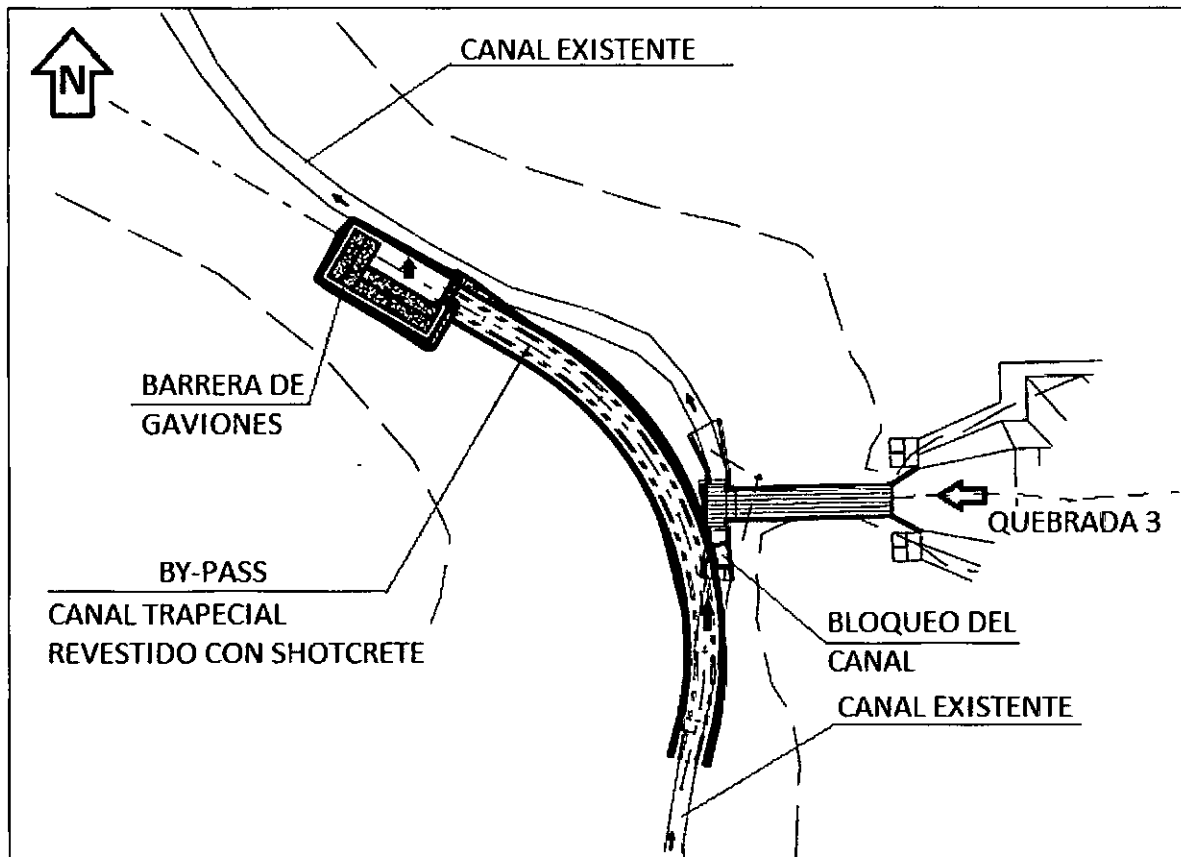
By-pass de canal en Obra de Arte N°3 – Canal Norte Superior
